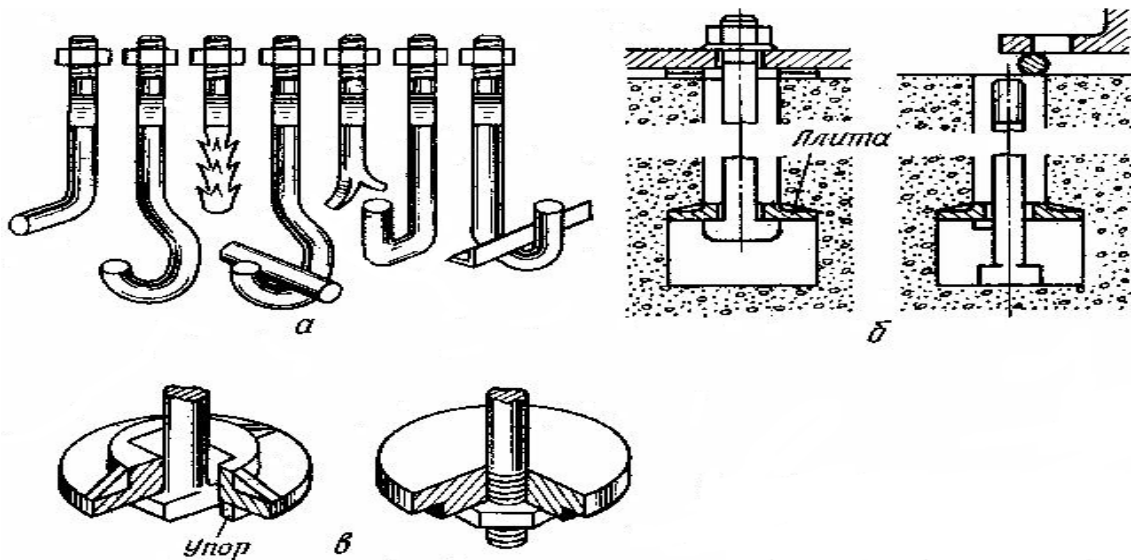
Фундаментні болти: *а* - залівний; *б* - фундаментний; *в* - варіанти кріплення нижнього кінця фундаментного болта.
